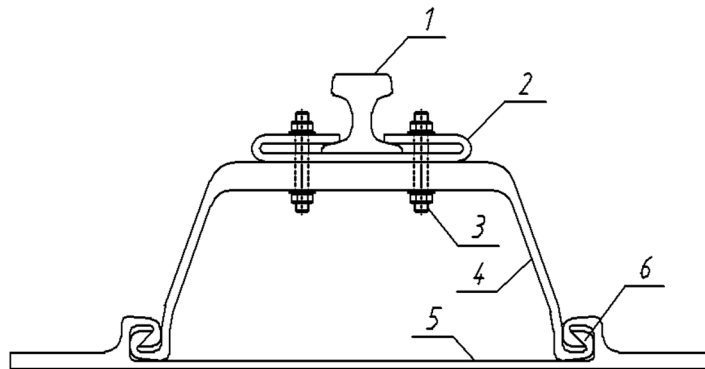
Сборный амортизирующий рельс: 1 – рельс КР-140; 2 – расширитель подошвы; 3 – шпильки; 4 – шпунт; 5 – затяжка; 6 – ответные шпунтовые соединения
